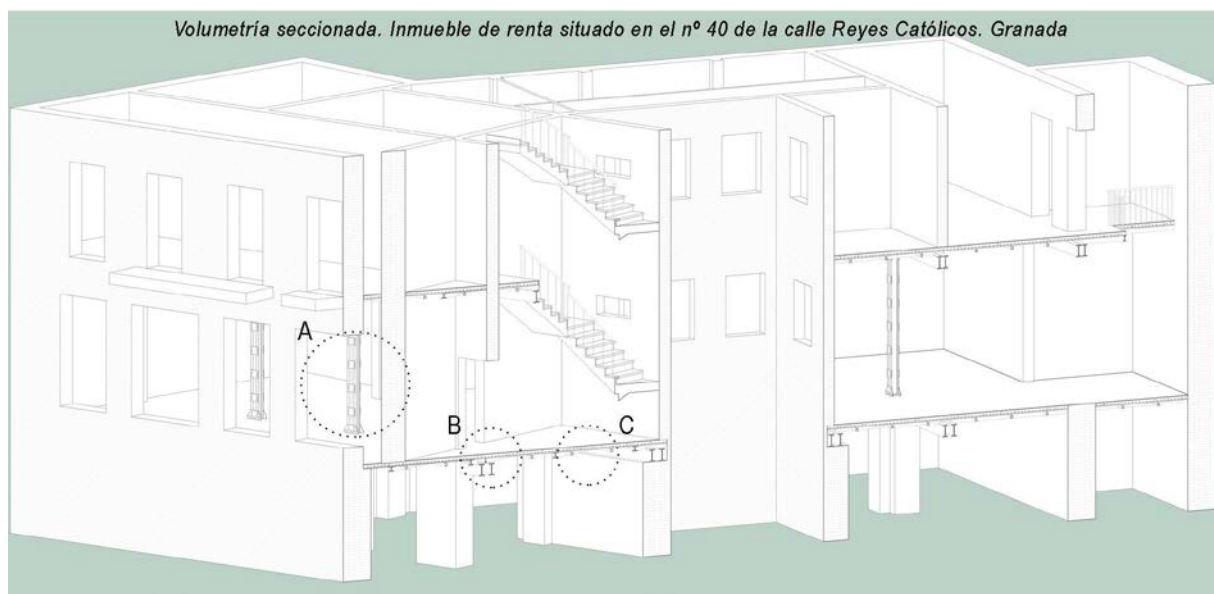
Axonometría del Inmueble de Renta sito en Reyes Católicos 40 –antiguo 37–. Reforma de Giménez Lacal (1929). Ubicación de detalles constructivos de las figuras 5 a 8. Fuente: elaboración propia.
